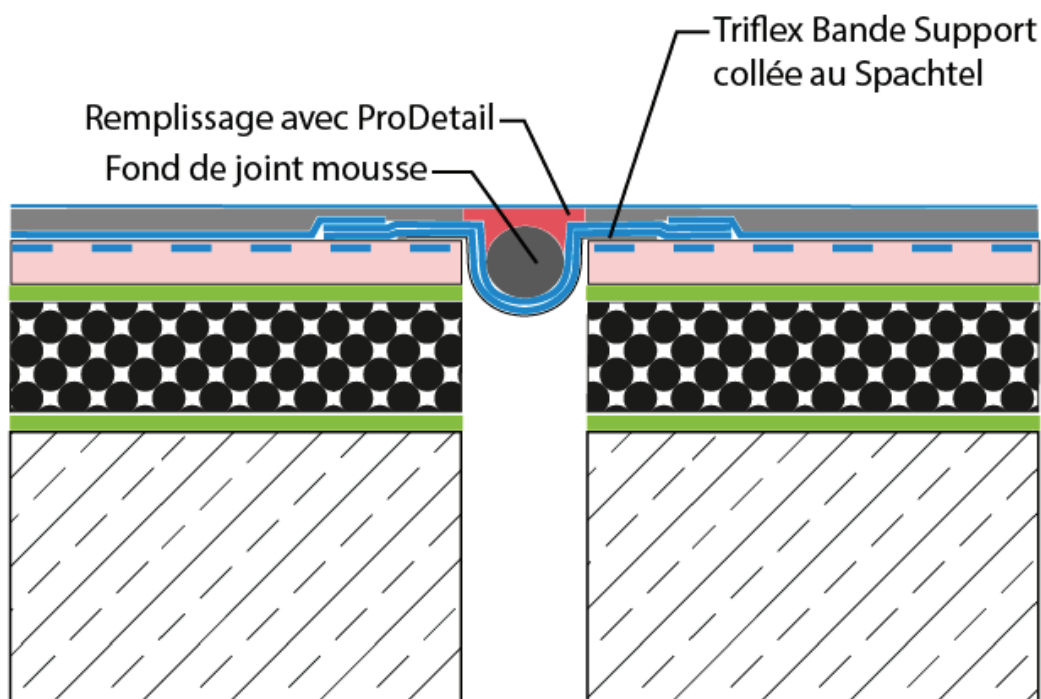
Coupe sur joint de dilatation système Triflex / FOAMGLAS®
